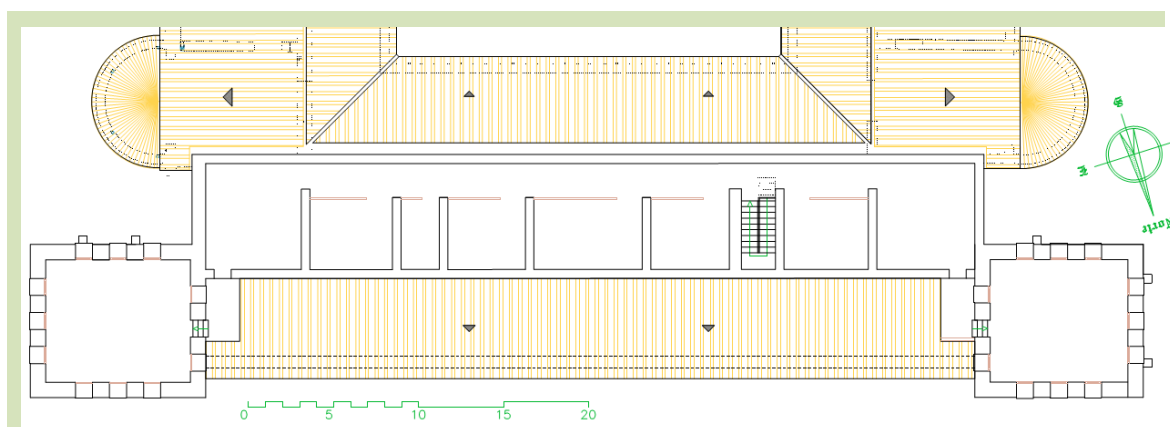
Ala norte, planta primera de La Olmeda (reconstrucción virtual-I). CGS.
